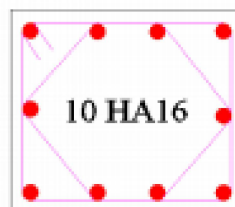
Ferrailage des éléments (poutres, poteaux)
